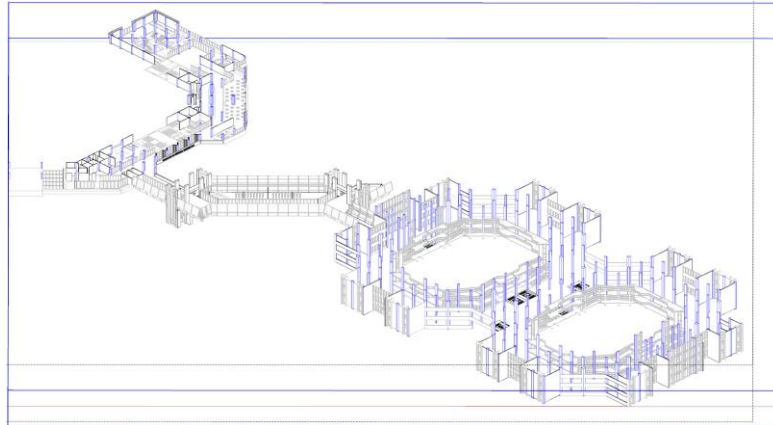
Etapa de diseño con énfasis en vigas de amarre y losas
